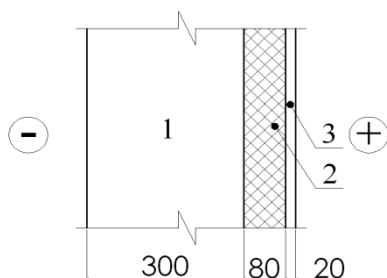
Конструктивная схема наружной стены для производственного здания с утеплителем толщиной 80 мм
